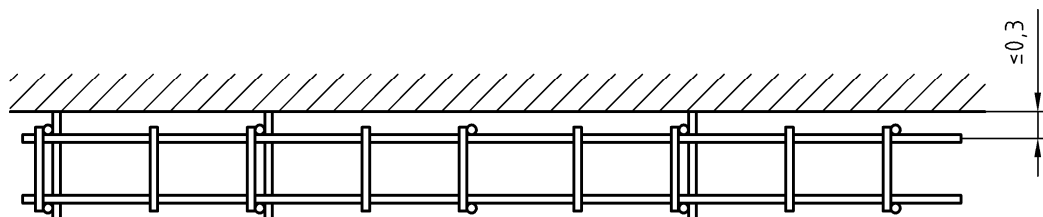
Anordnung der Stoßkupplungen bei Ständerstößen (jeweils in den beiden obersten Lagen) für die Regelausführung für Stahlrohr-Kupplungsgerüste als Standgerüste mit längenorientierten Gerüstlagen
